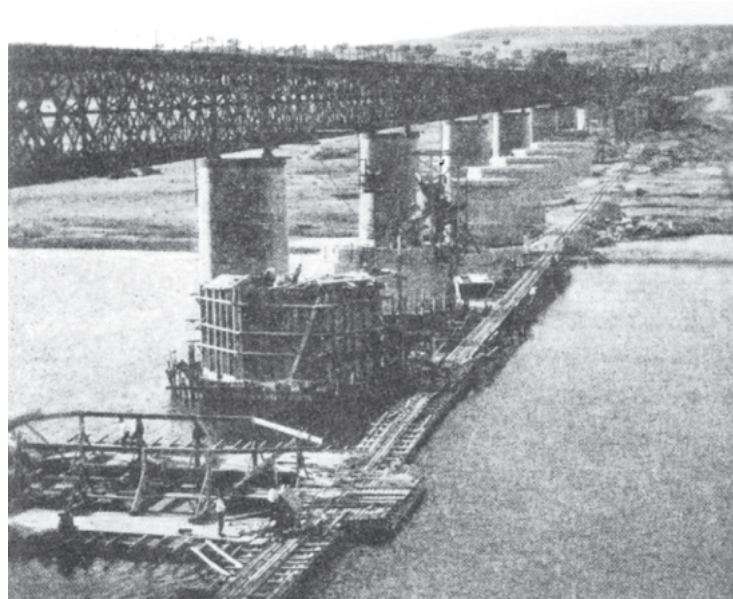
Puente de la Compañía Eiffel en segundo término. Delante construcción del Puente de Fernando del Pino. Enrasadas al arranque de arcos varias pilas del nuevo puente; otras en construcción y, en primer término, empezando el encofrado de una de ellas. (Fotografía reproducida en el artículo citado de F. del Pino).
